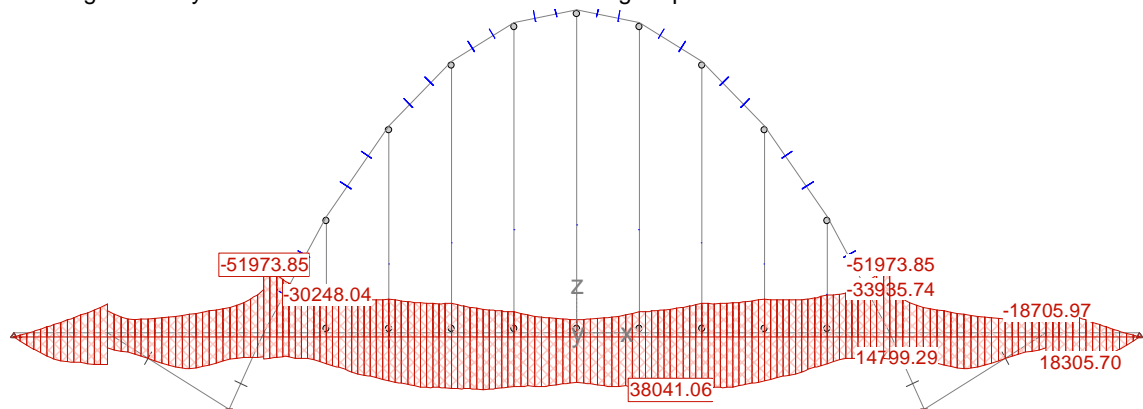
Ley de momentos en ELU debida a las cargas que actúan sobre la estructura mixta.
